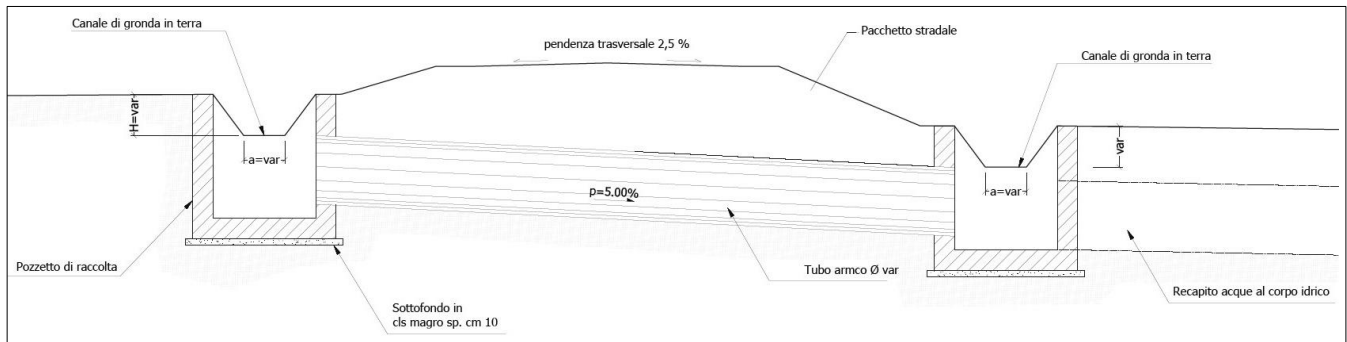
Sezione tipo in corrispondenza dell'attraversamento idraulico.
